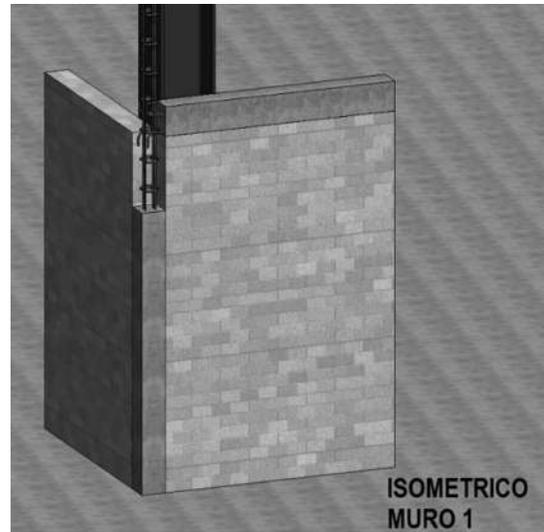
Esquema de muro de block de concreto. Fuente: Elaboración propia
